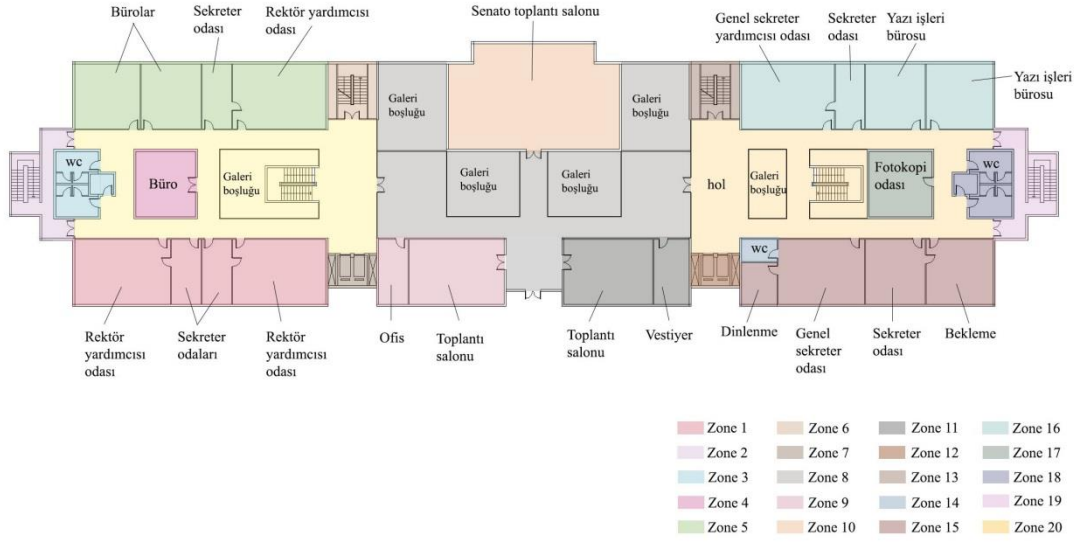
Rektörlük binası 4.kat planı ve ısı bölgeleme.
